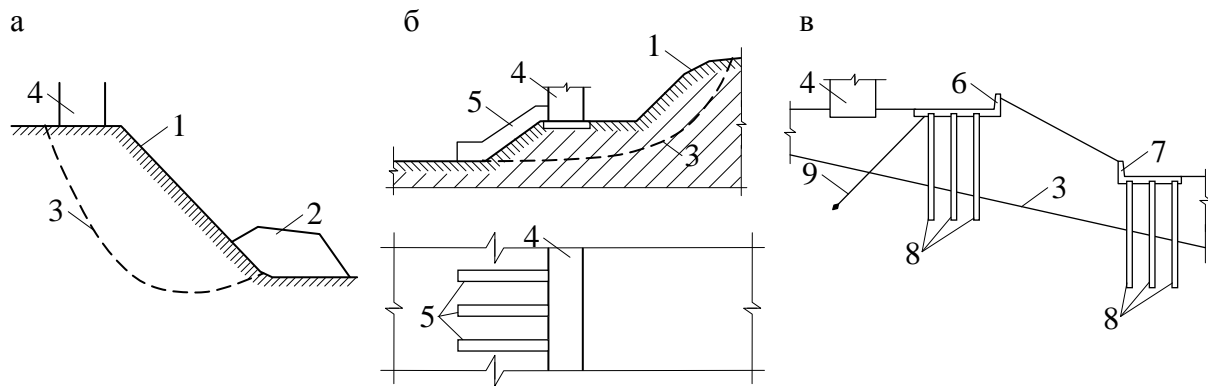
Підсилення схилів: а – контрбанкетом; б – контрфорсом; в – утримуючими конструкціями; 1 – поверхня схилу; 2 – контрбанкет; 3 – поверхня ковзання зсуву; 4 – будівля; 5 – контрфорс; 6, 7 – верхня та нижня утримуюча конструкції; 8 – буронабивні палі; 9 – анкер
